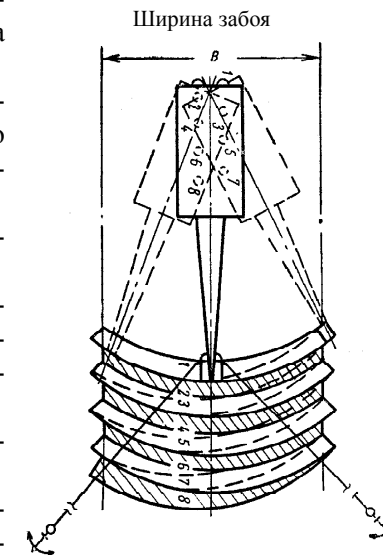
Разработка грунта плавучим снарядом по способу папильонирования:
